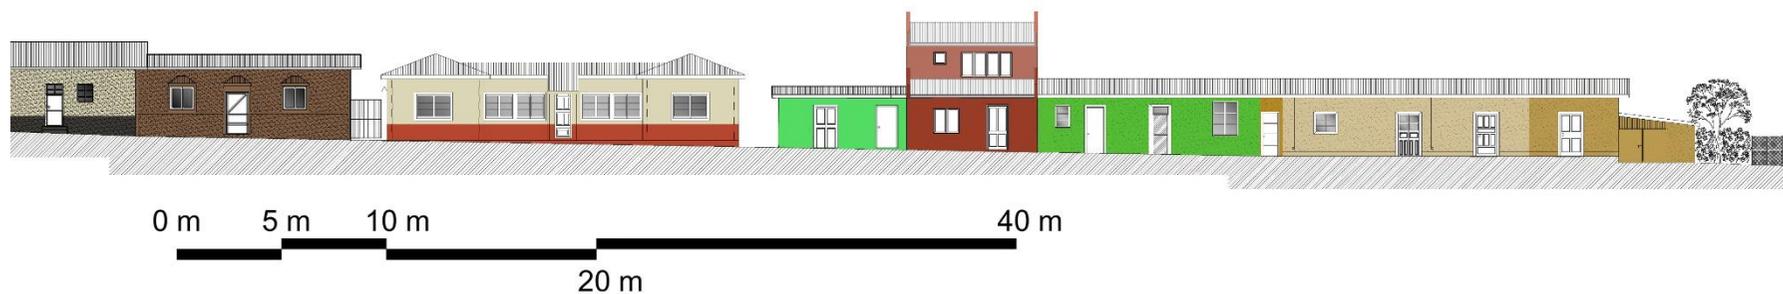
Elevación fachada principal ejemplo de casa de 1 recinto 1 zaguán (vivienda de 2 pisos)
